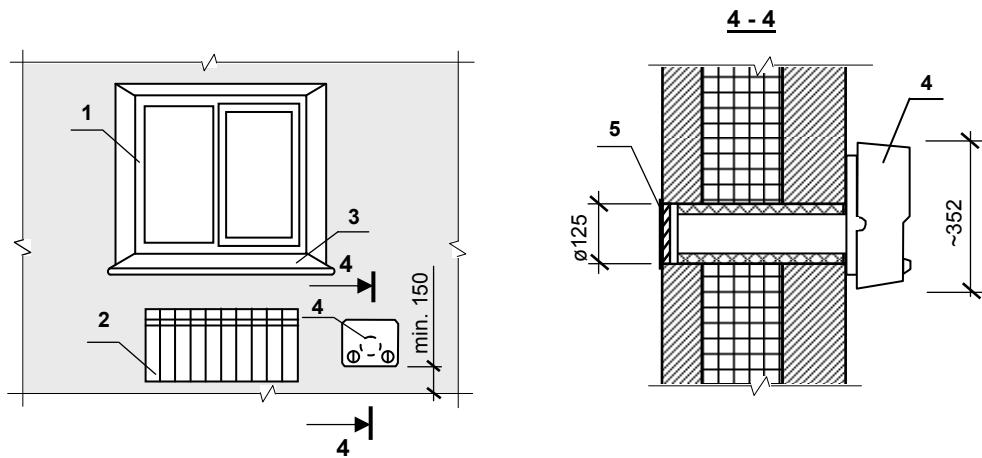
Принципиальная схема монтажа приточной вентиляционной установки с подогревом приточного воздуха (1 – оконный блок; 2 – отопительный прибор; 3 – подоконник; 4 – приточная вентиляционная установка; 5 – наружная решетка)
